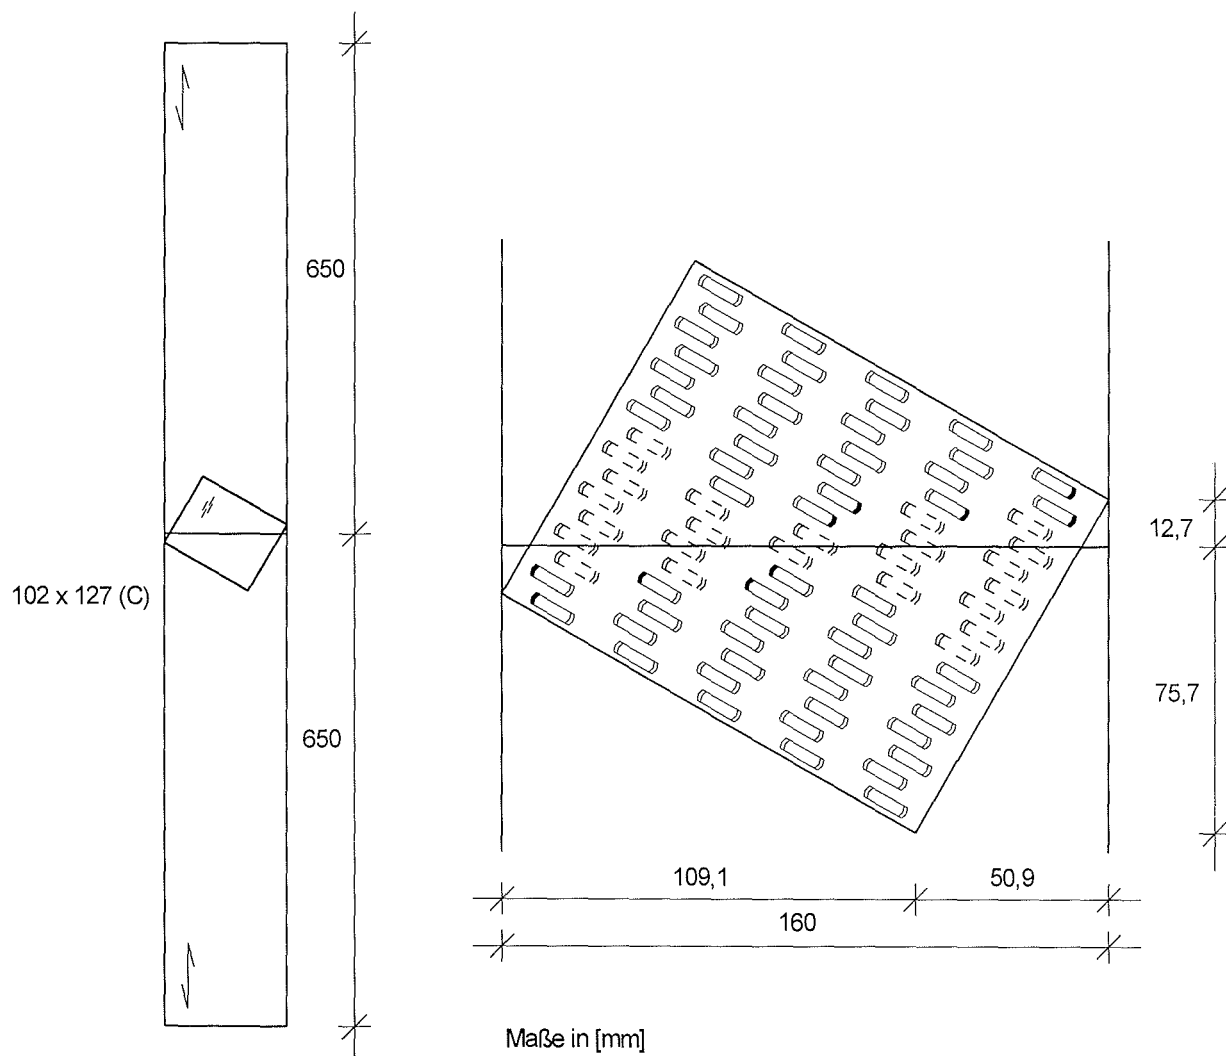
Form und Abmessungen der Zugprüfkörper Reihe M60
